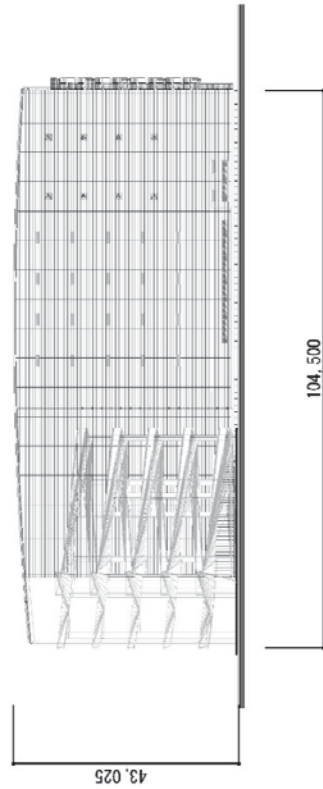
(1) 計画建物立面图 (業務地区 B)
